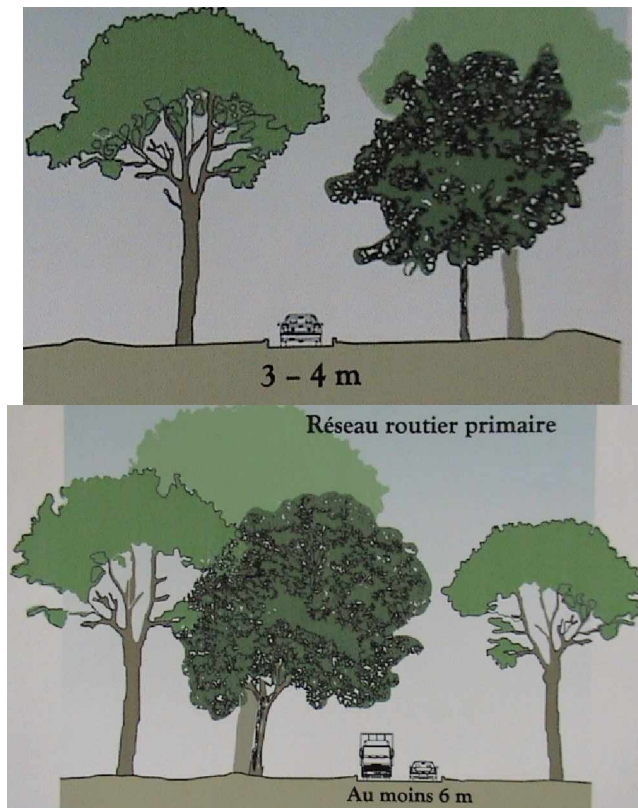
plans des pistes (primaire >6m et secondaire <4m et >3m) [Dossier Technique]
